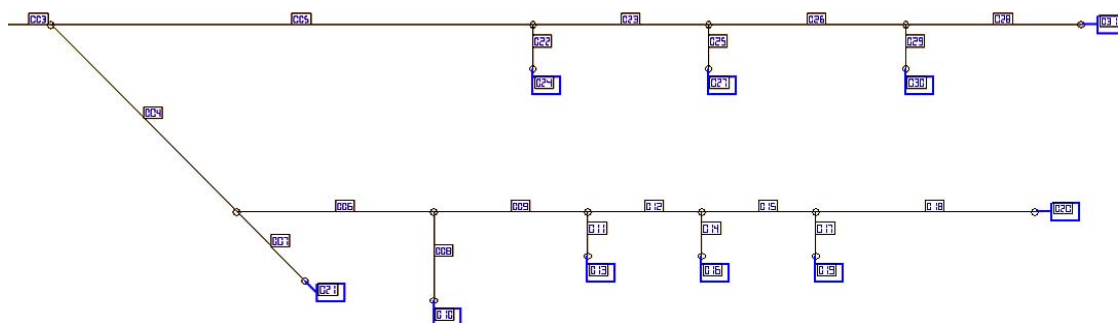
Esquema del circuit de refrigeració de la planta baixa
